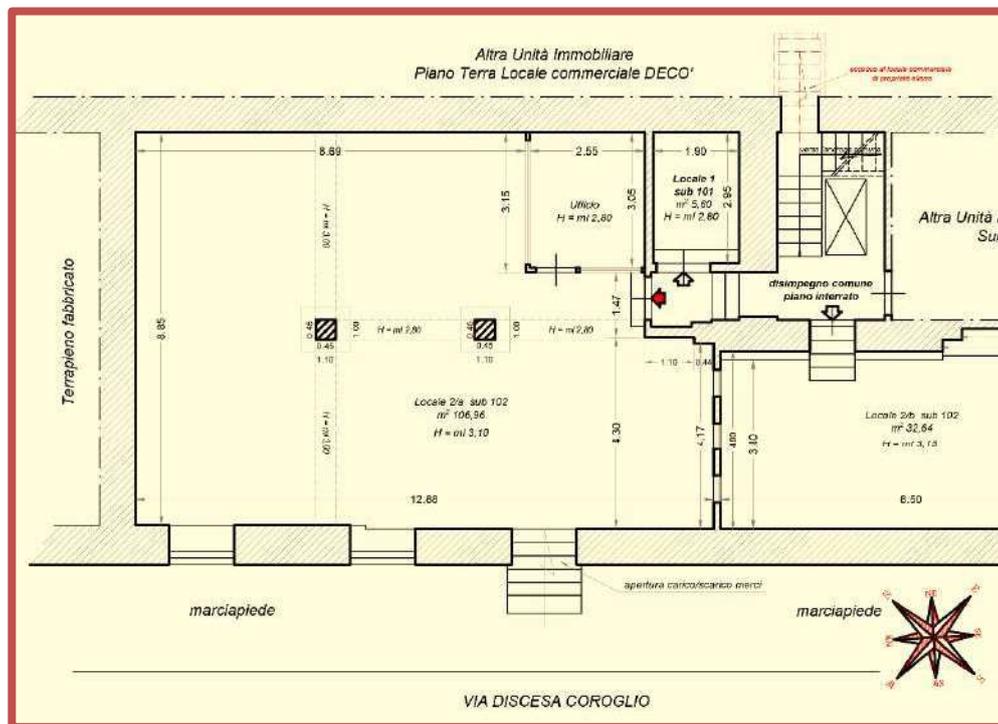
Stralcio planimetrico fuori scala dell'accesso al "Locale 2/a Sub 102".
